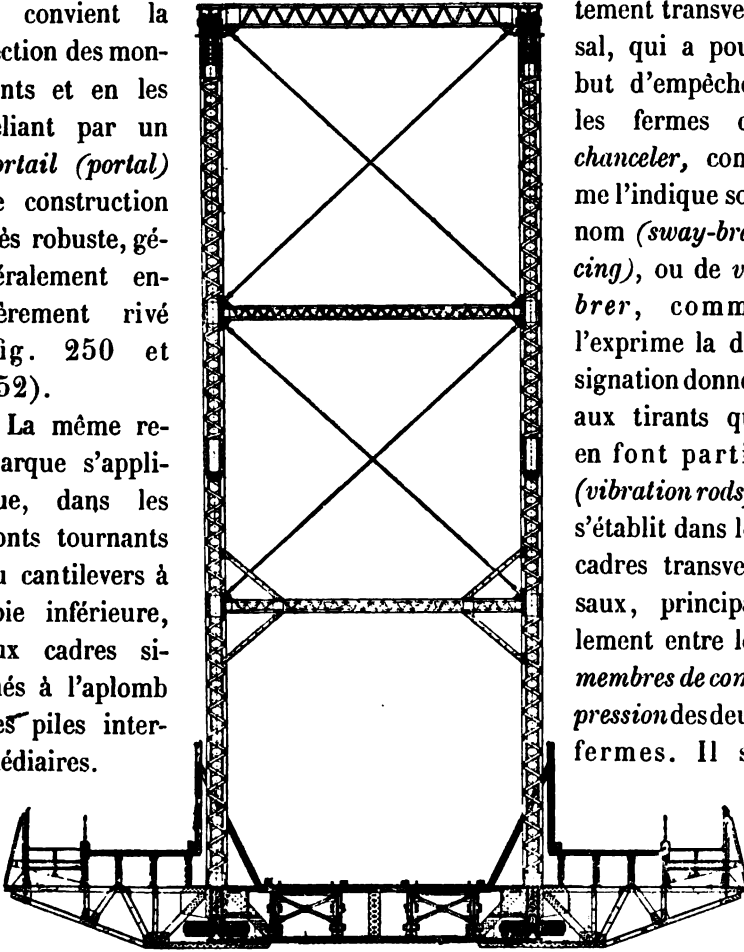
Pont de Cincinnati et Covington. — Coupe centrale de la travée de 167^m.75.
